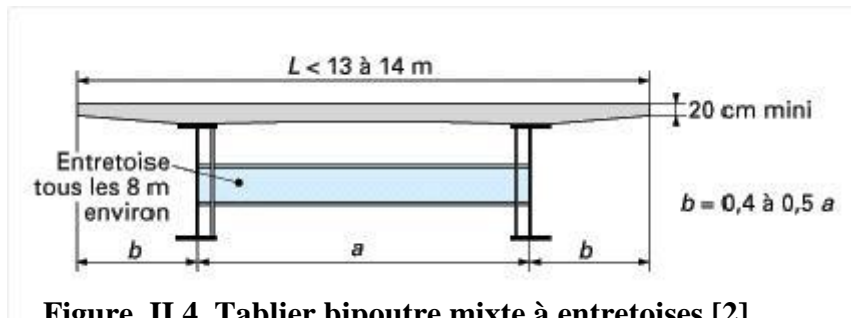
Tablier bipoutre mixte à entretoises [2]
